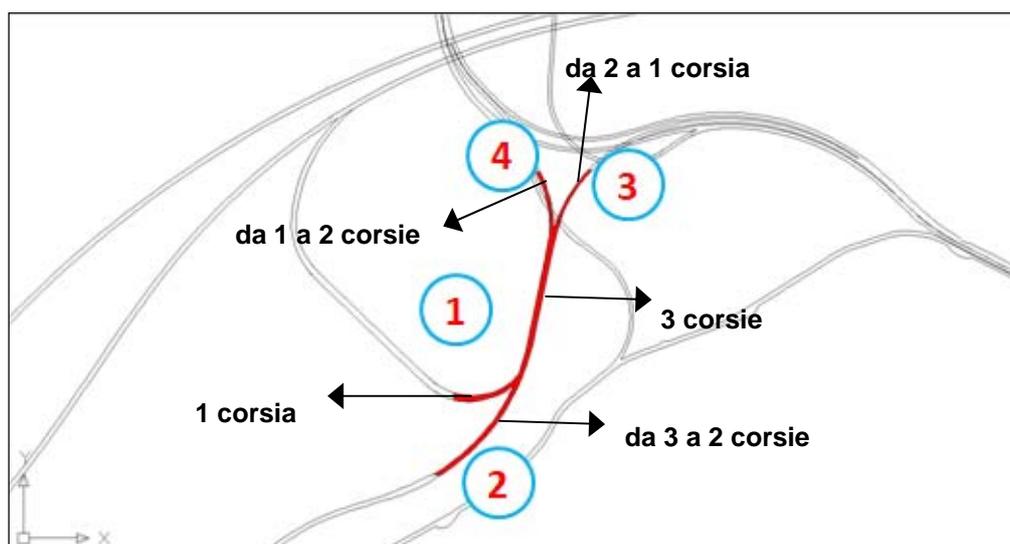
Schema di rete (variazioni da layout attuale a progettuale)
